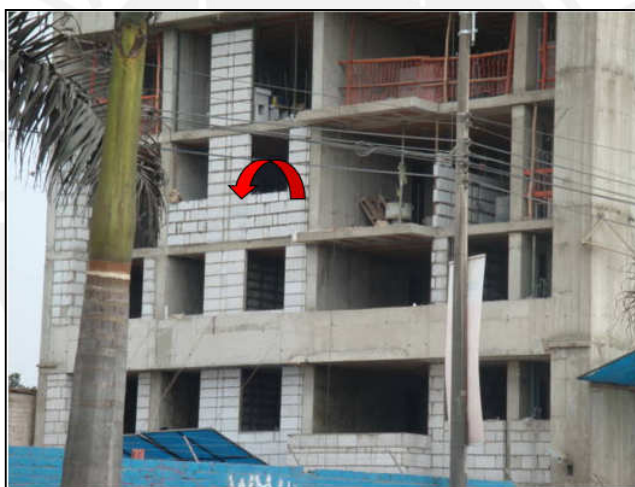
Edificio de concreto armado con albañilería silico calcárea.
